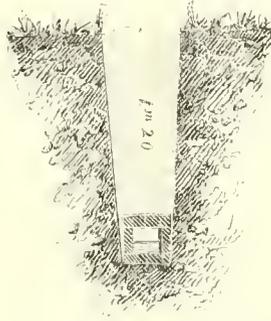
Coupe en travers d'un drain à section rectangulaire.
